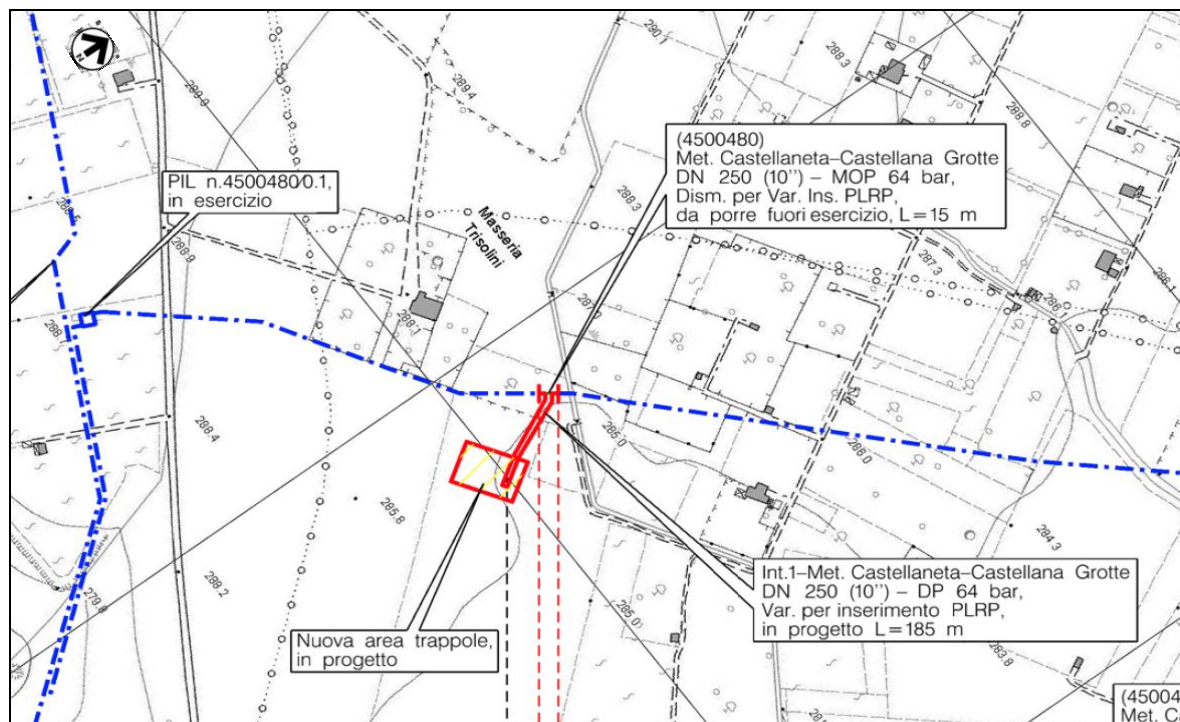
/E – Planimetria 1: 5.000 con localizzazione della VARIANTE dell'area dell'Intervento n.1 (opere in progetto in rosso, dismissione in verde, esistente in blu)
